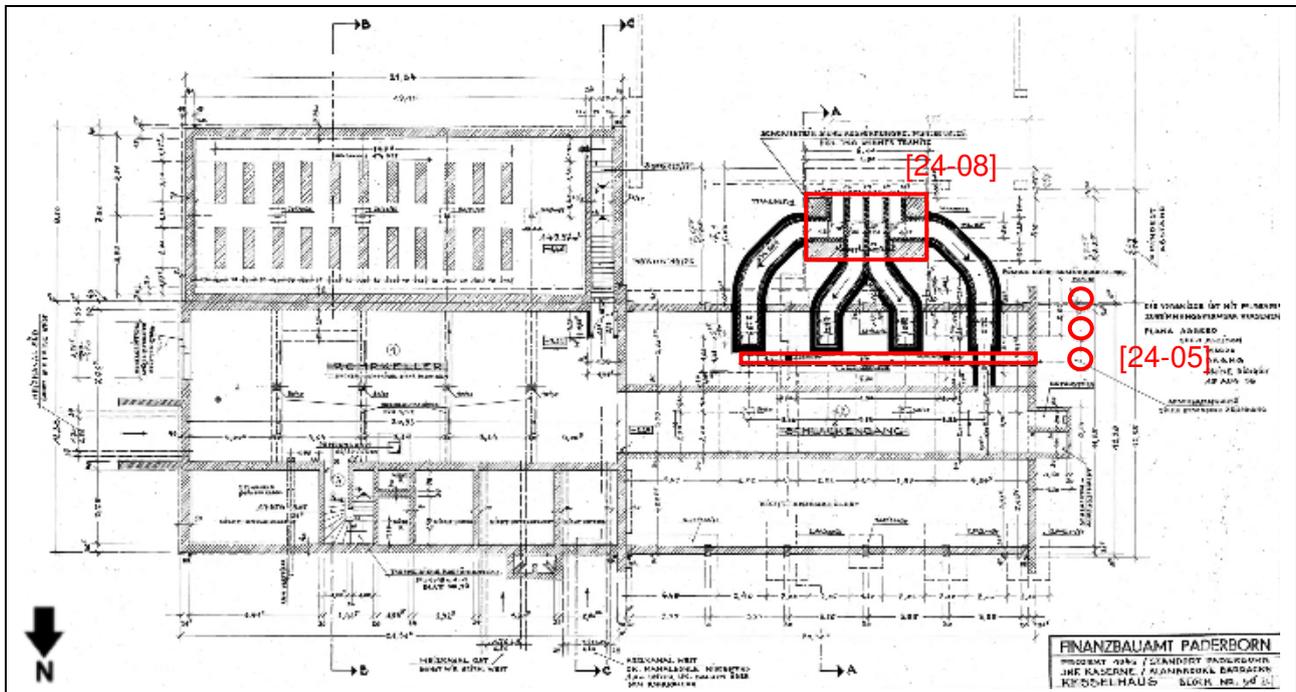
Heizzentrale (Grundriss/KG - 1957) (Quelle: BIMA Münster)
